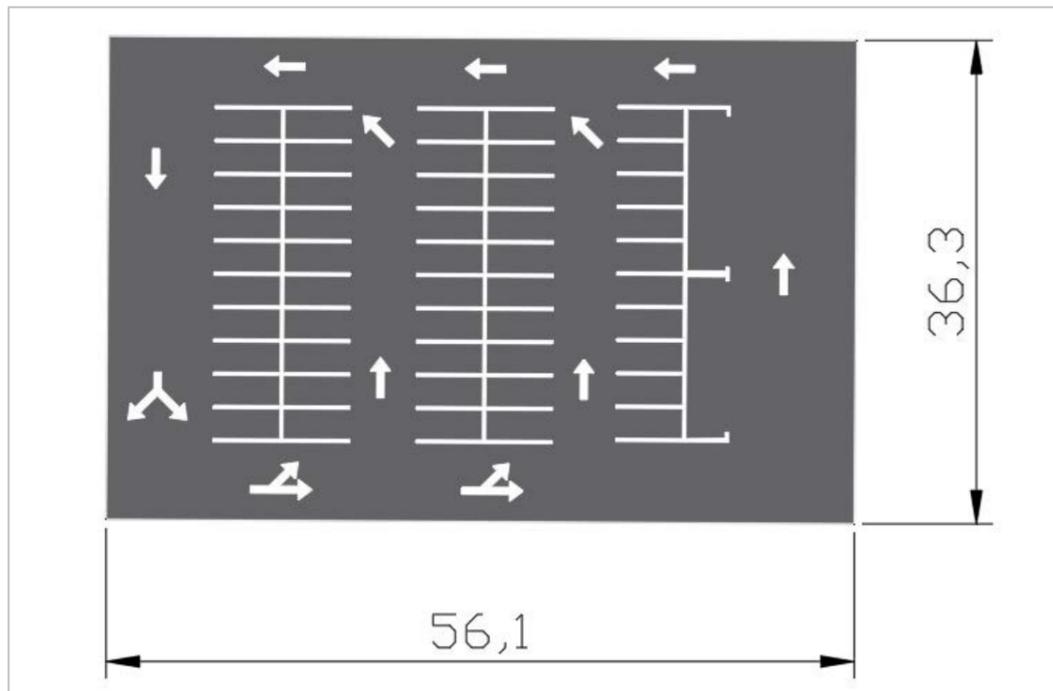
Diseño en planta del aparcamiento. Fuente: Autor
